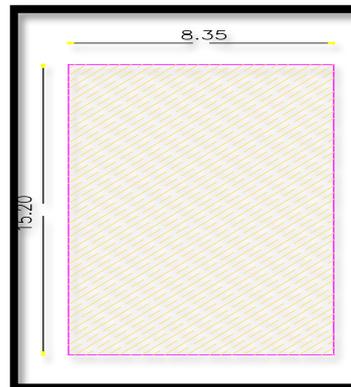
Geometría en planta Vivienda B1 (pisos 1,2 y 3)
